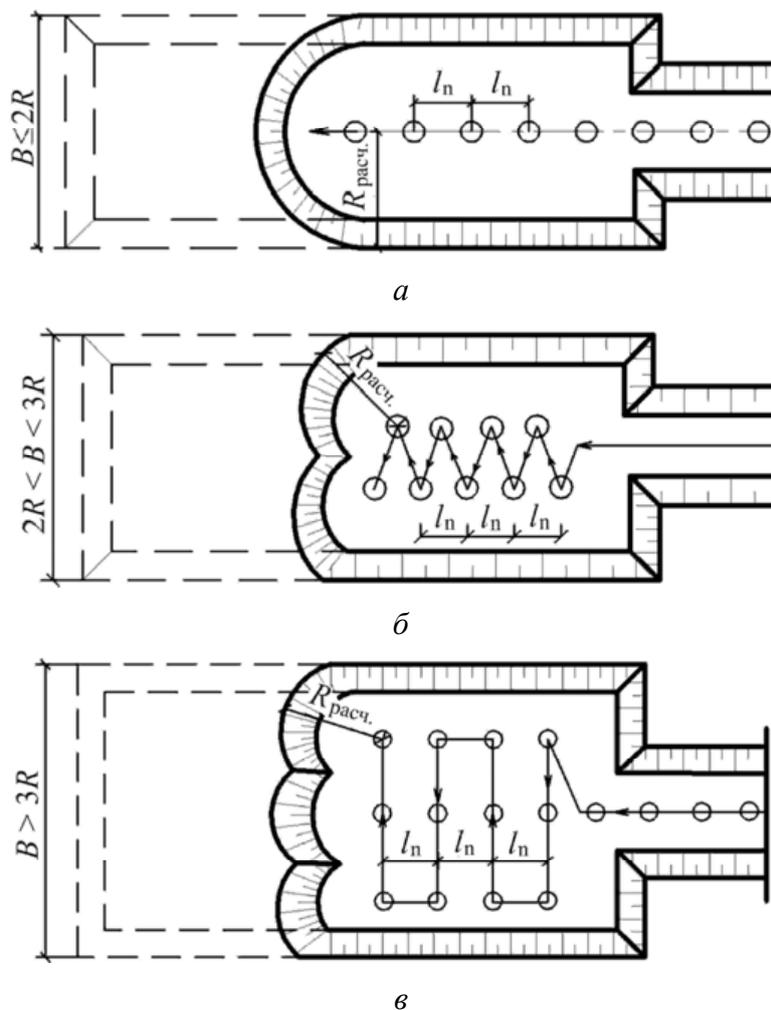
Схема разработки котлована лобовой проходкой: а — с перемещением экскаватора по прямой линии; б — зигзагом; в — поперек котлована
